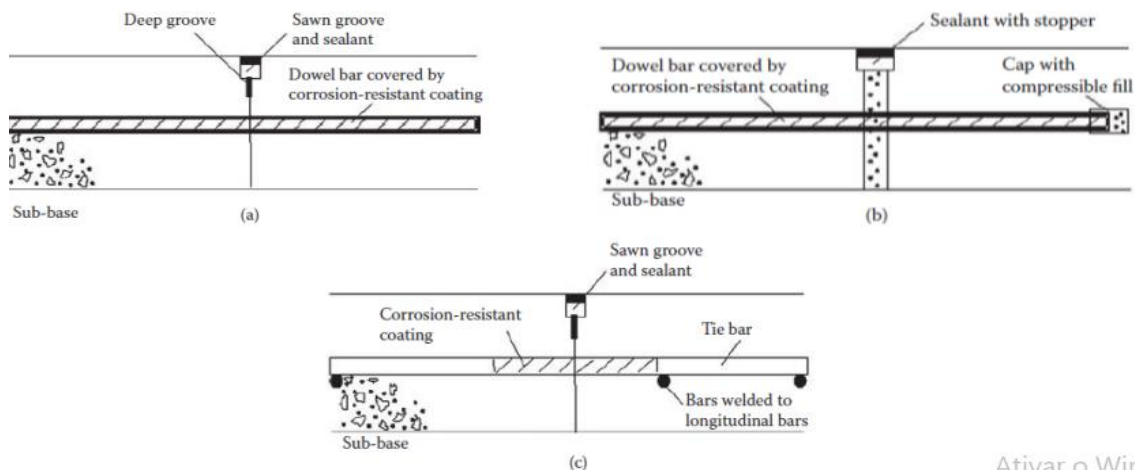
Tipos de juntas e pormenores construtivos. [Nikolaides, (2015)]
